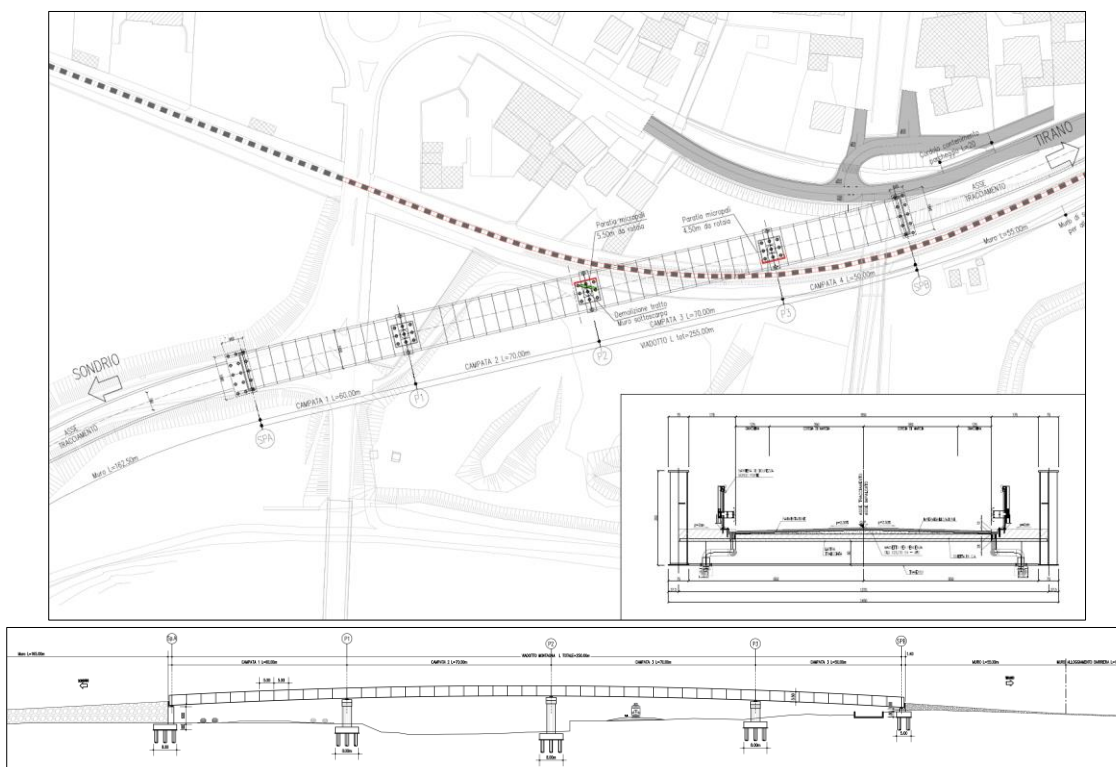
Cavalcavia in progetto, planimetria e sezione
